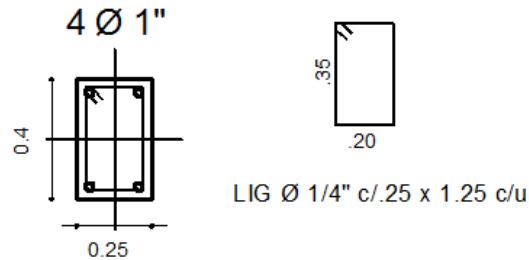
8 Detallado de sección transversal de columna del quinto piso ejes A y B
